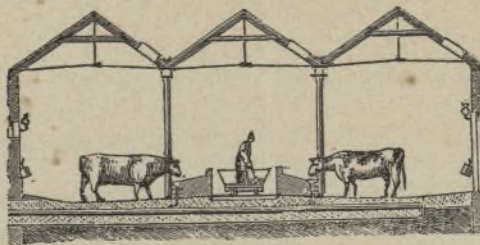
PROFILO DI VACCHERIA con trottoio a sopraelevazione situato contro il muro di faccia.
